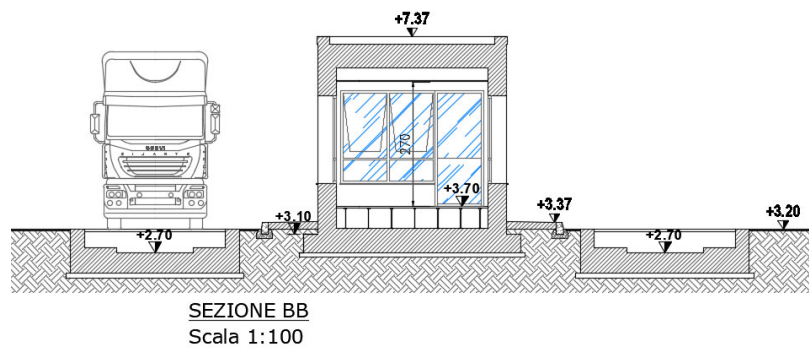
sezione trasversale edificio pesa e pesa a ponte
